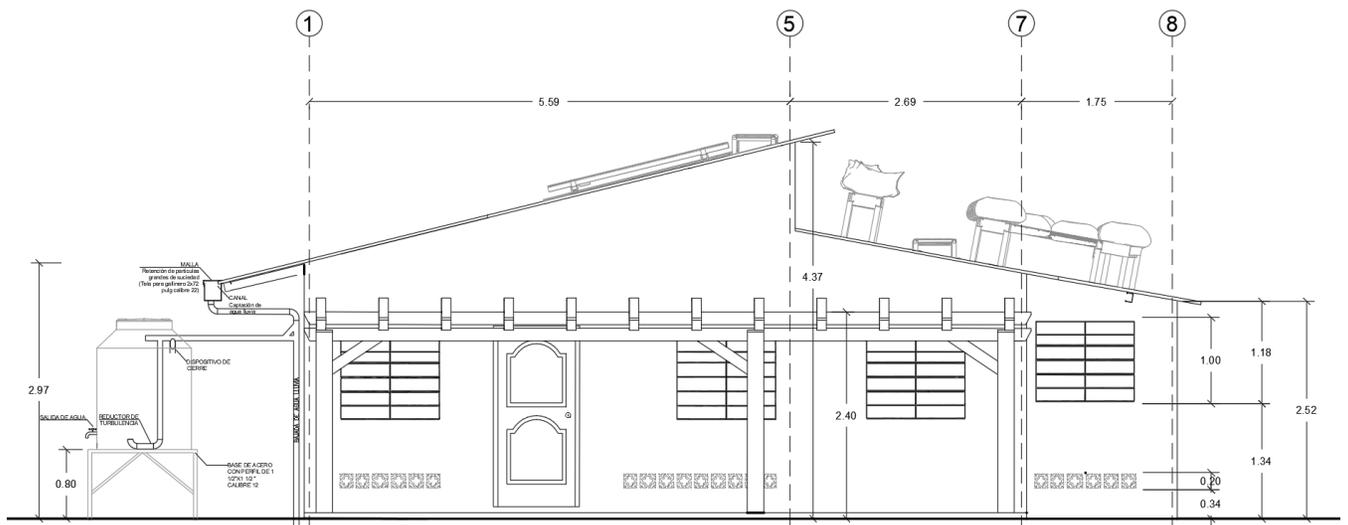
Fachada Este, acceso principal de la vivienda. Fuente. Creación propia
